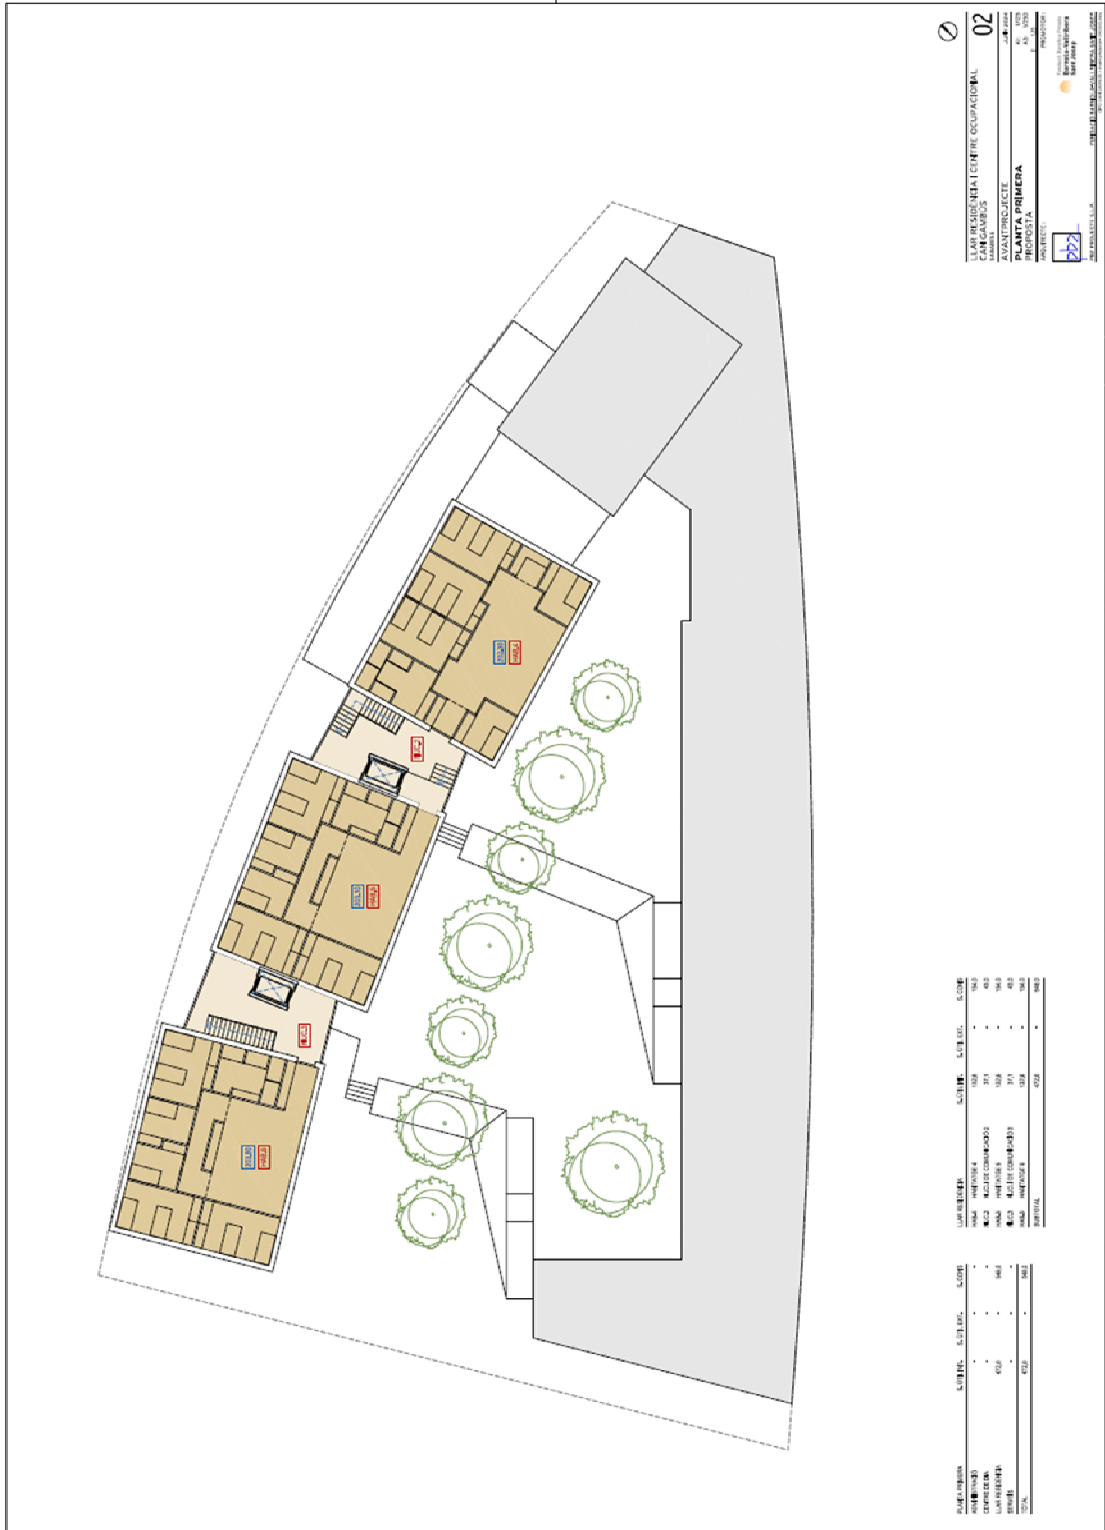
Avantprojecte de la proposta: Plànol 02. Planta primera
